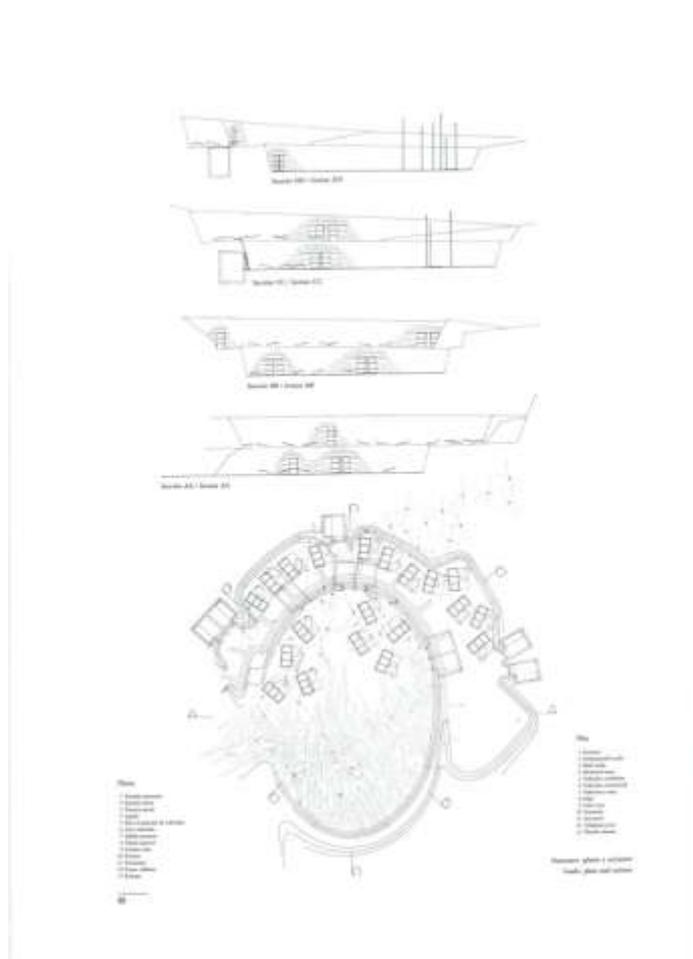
Planta e cortes da área uterina. (Levene, 2005, p. 66)
